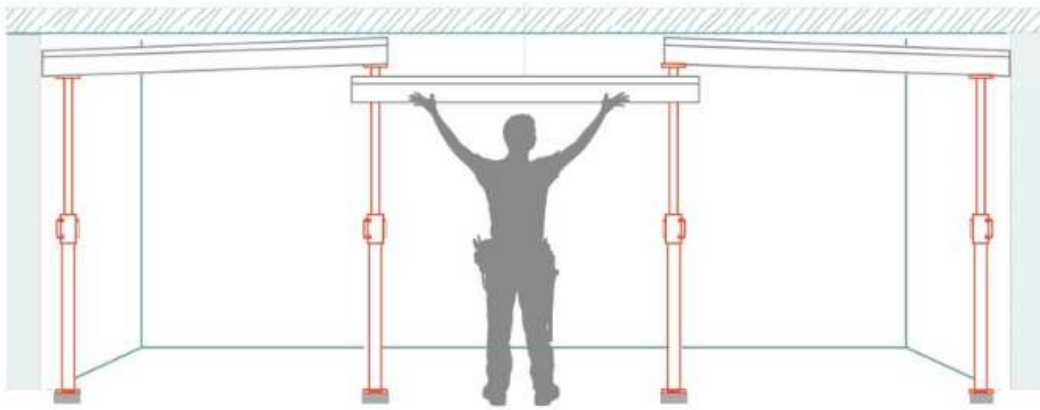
Ubicación del perfil central. Fuente: <http://goo.gl/7XlgiY> (04/06/2015; 17:51)
